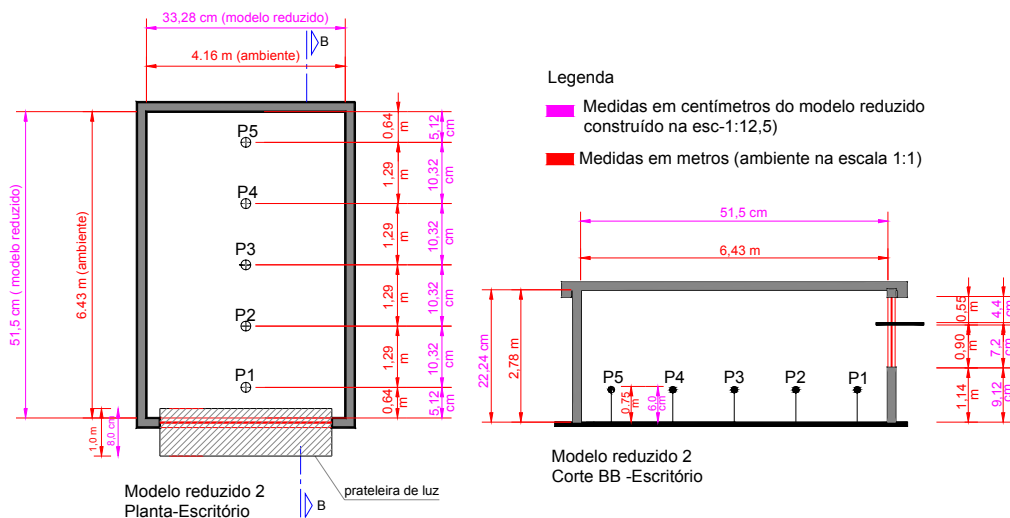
Planta e corte do modelo reduzido 2 - Escritório
